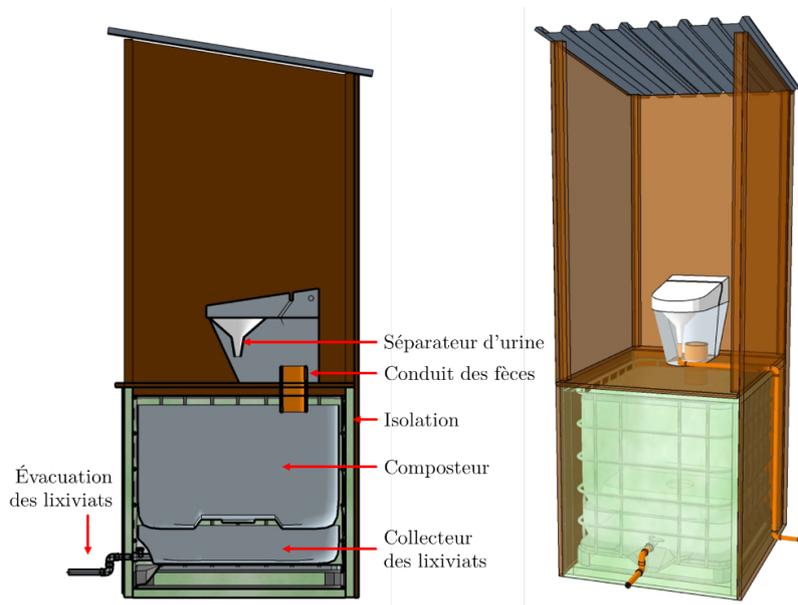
Plan de la cabine de toilette extérieure auto-construite.
